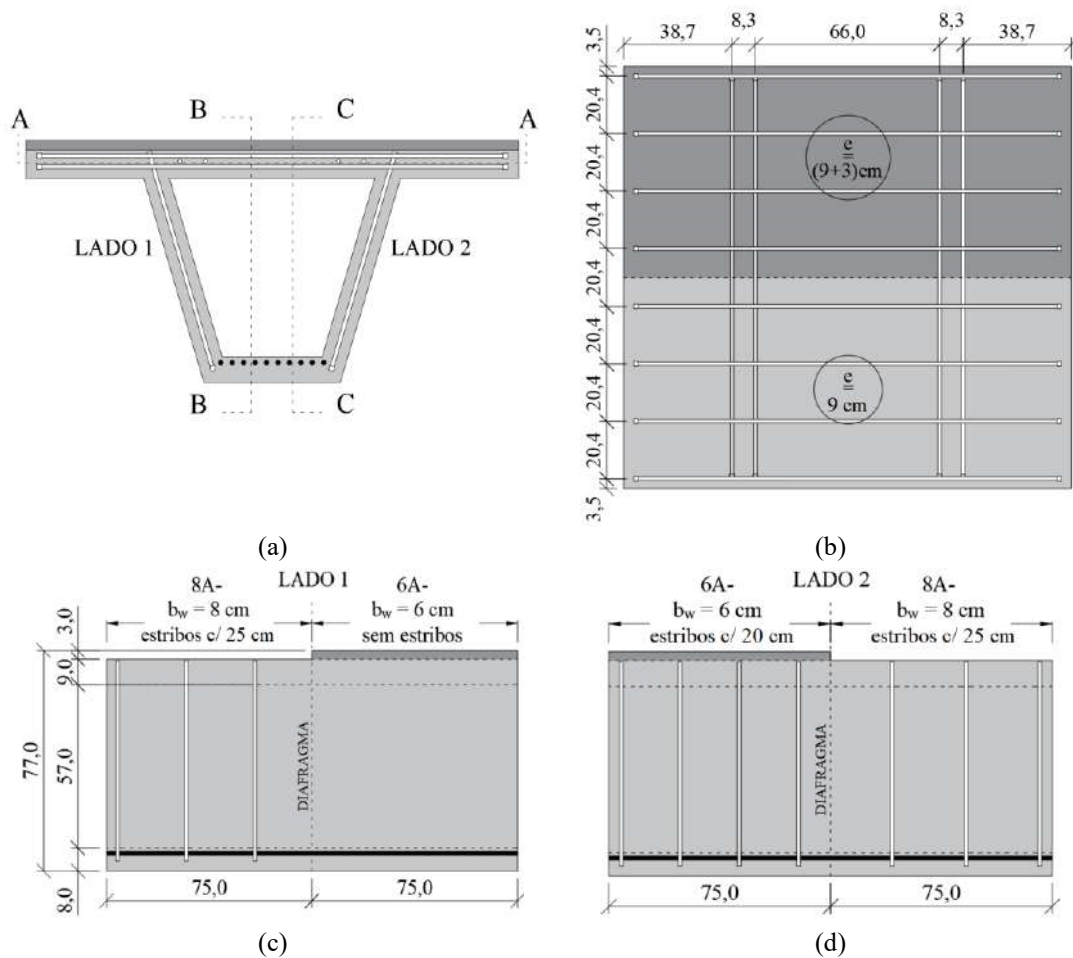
Previsão da distribuição da armadura de PVC: (a) seção transversal, (b) Corte A-A, (c) Corte B-B, e (d) Corte C-C; dimensões em cm.
